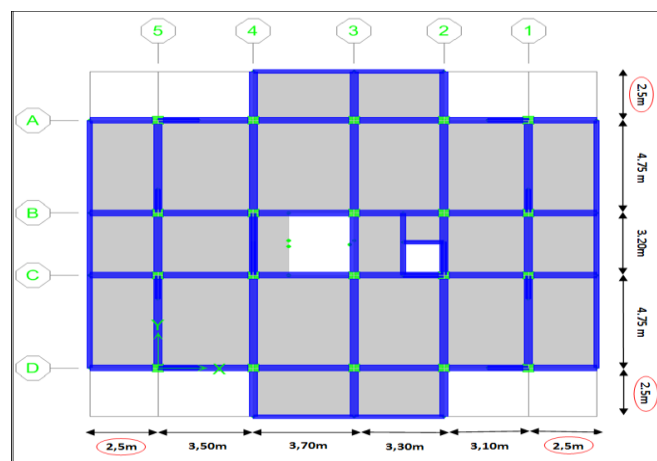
Vue en plan de la structure STR3 (2,5m).
